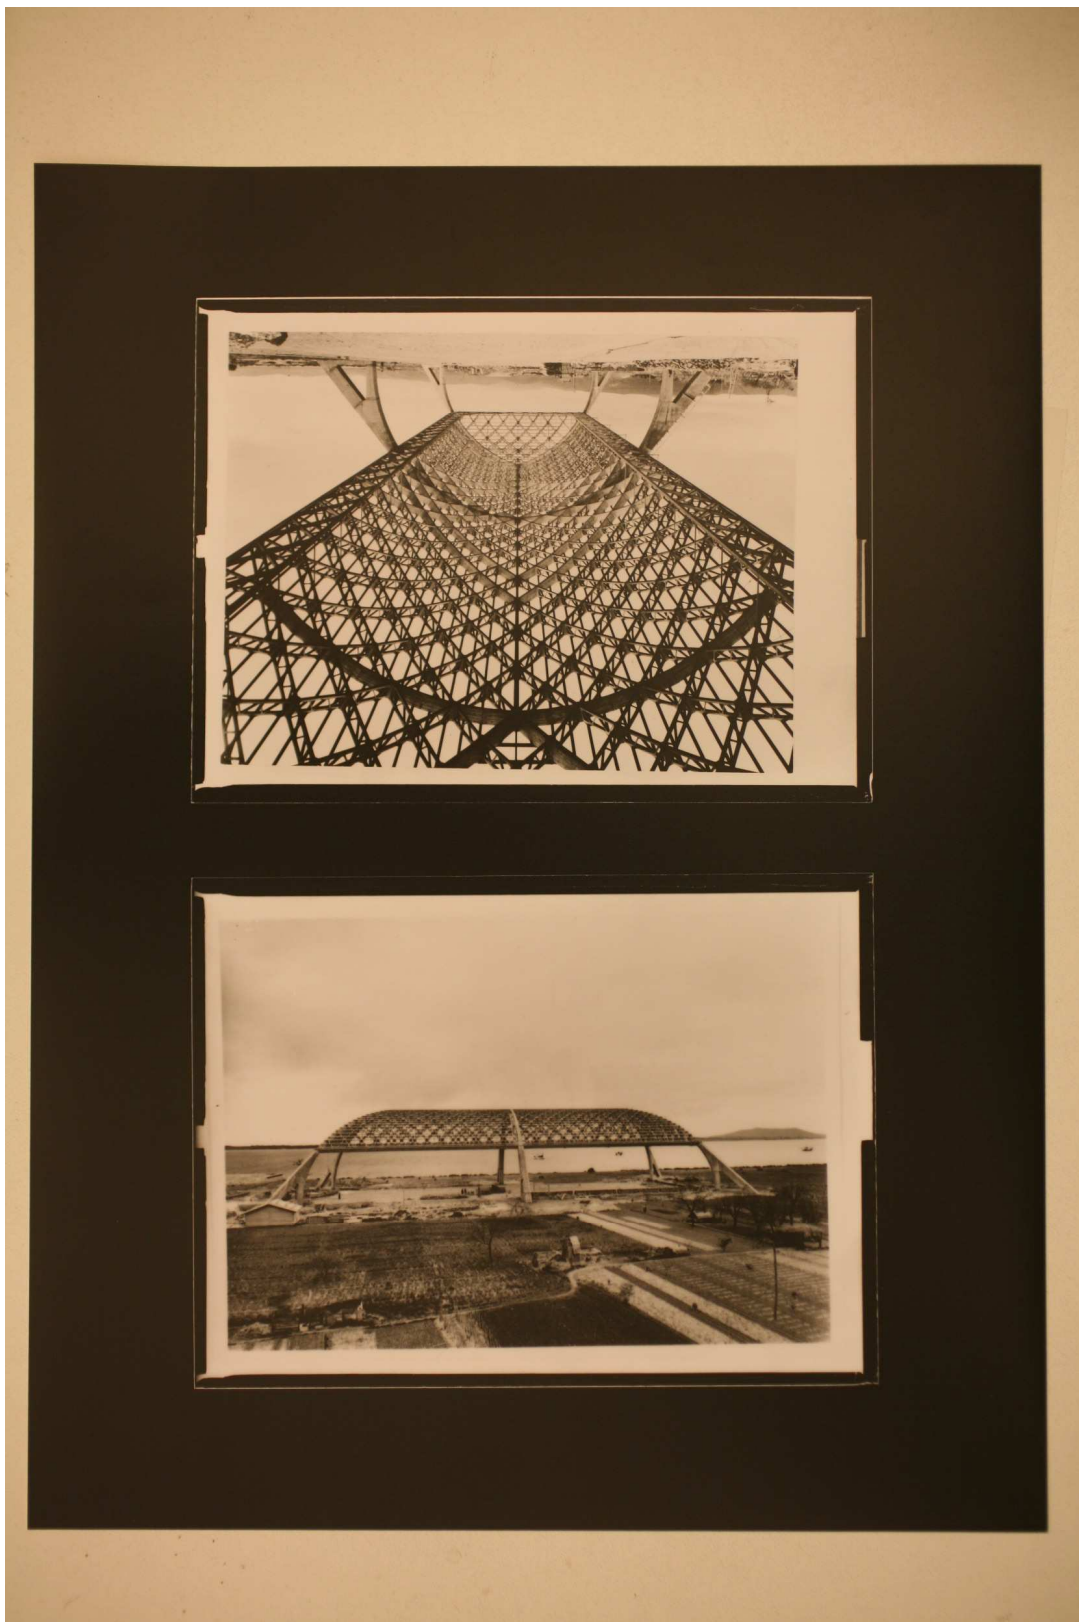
, Archivio Vasari, (Cantiere aviorimessa II tipo), 1939-42, CSAC, sezione fotografia.
